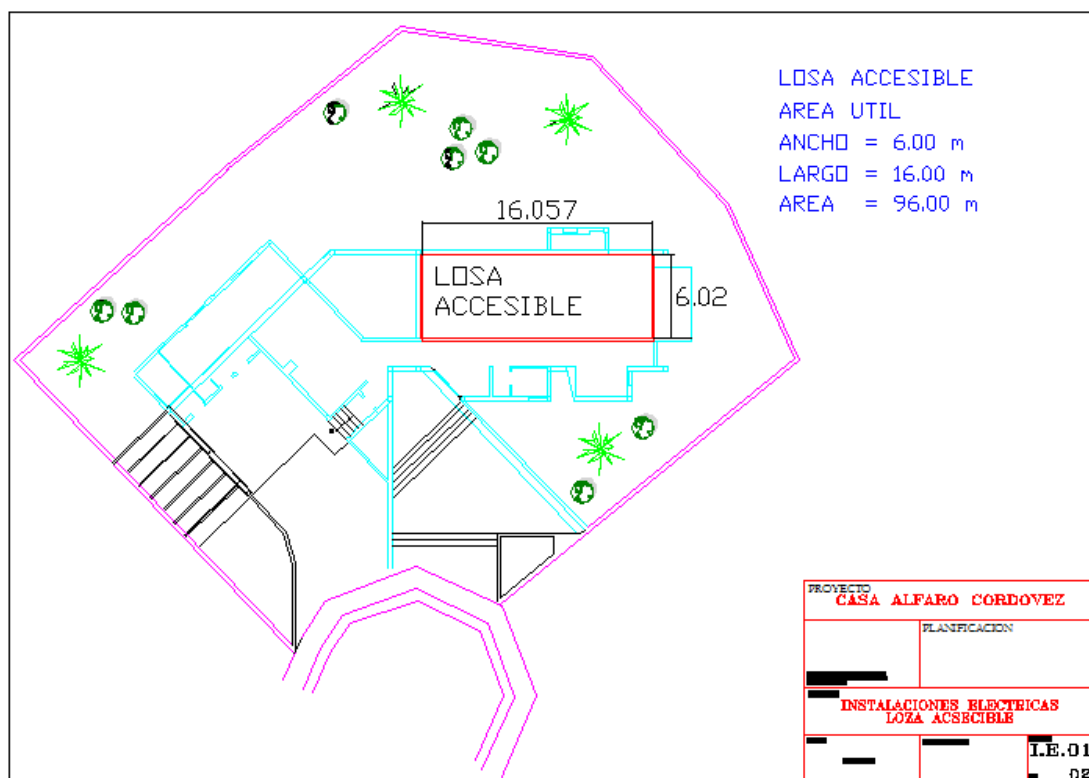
Plano arquitectónico losa accesible de la residencia Alfaro ubicada en Quito, Cumbaya.
